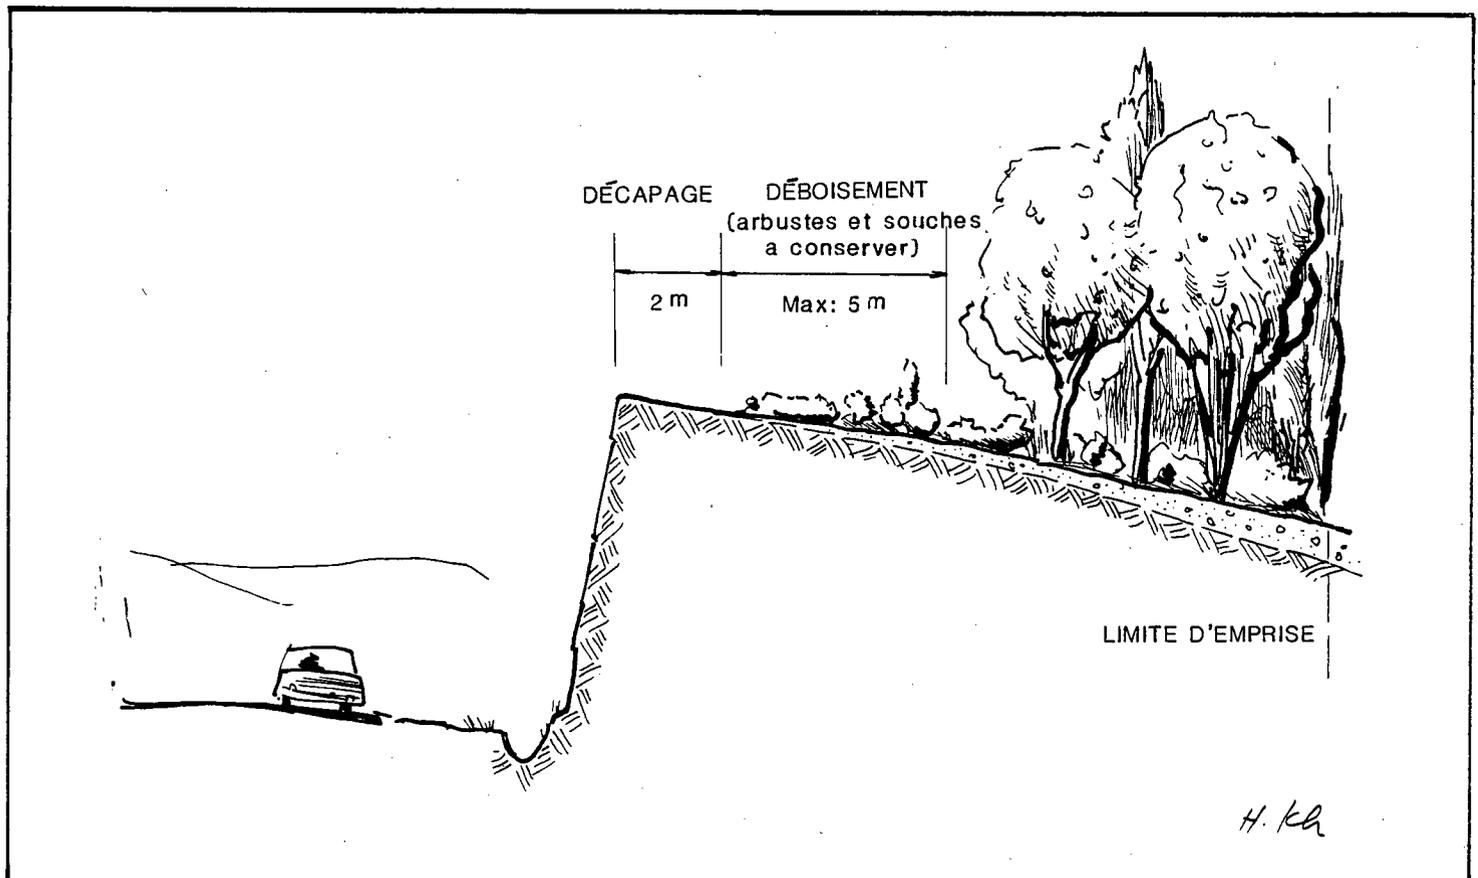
DEBOISEMENT DU HAUT D'UNE COUPE DE ROC SANS FOSSE DE DRAINAGE
